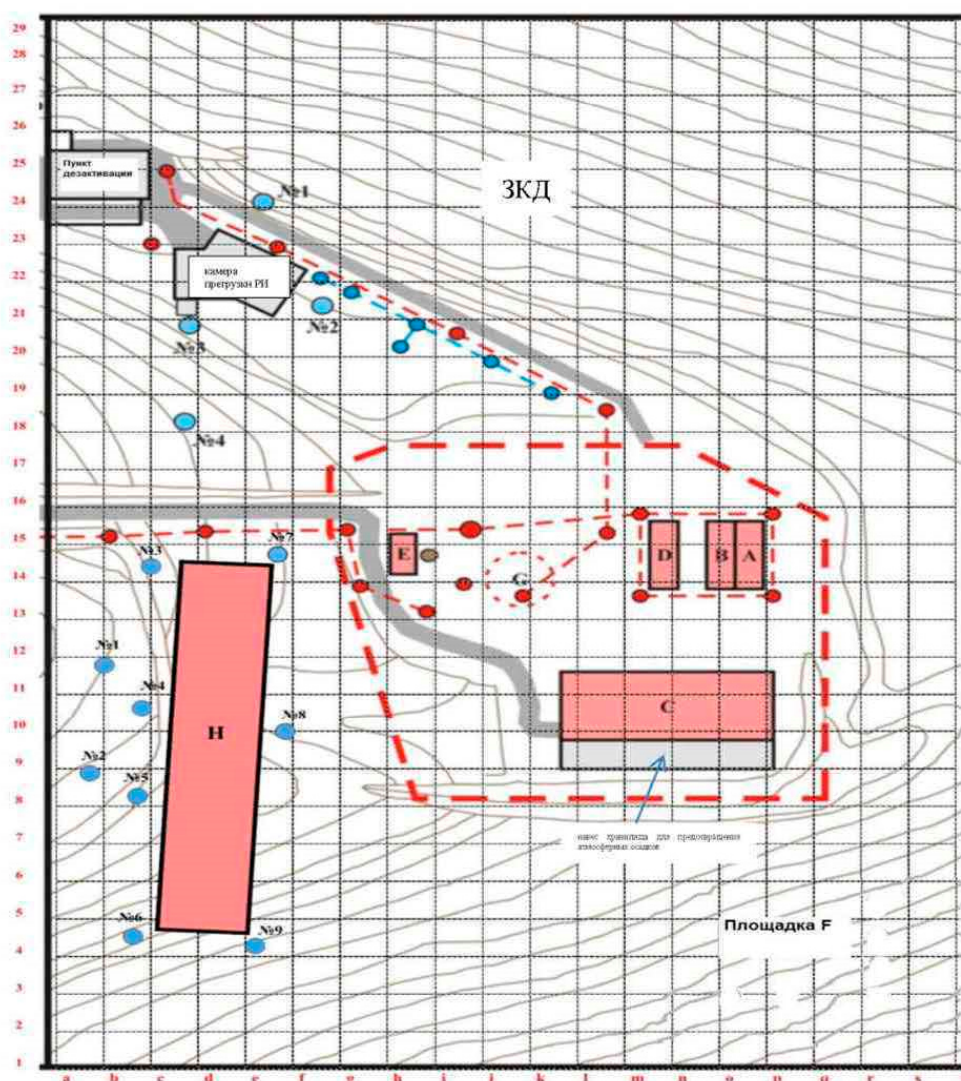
Схема размещения хранилищ РАО на ПХРО Саратовского отделения
